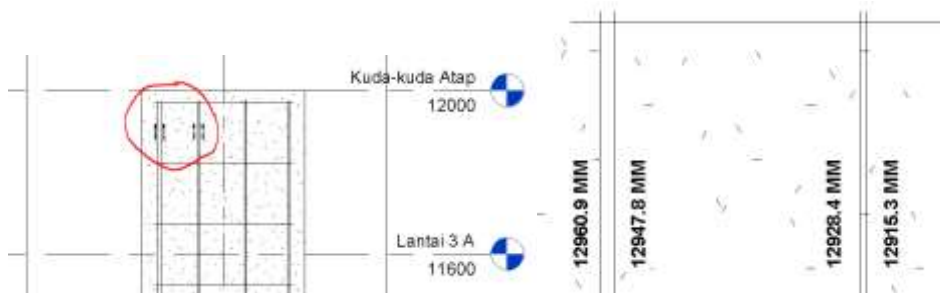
Selimut Beton (15 cm) Pada Salah Satu Pondasi
